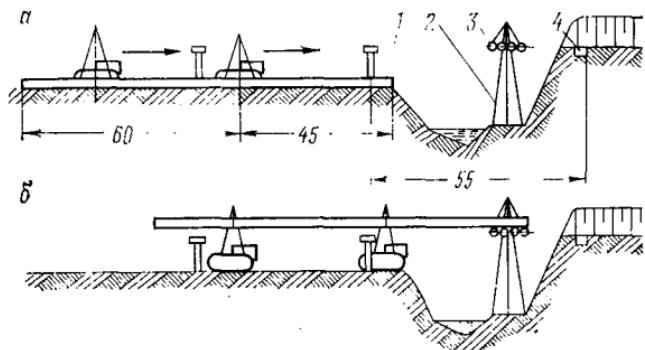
Схема монтажа перехода с устройством временной опоры с тrolleyной подвеской:
